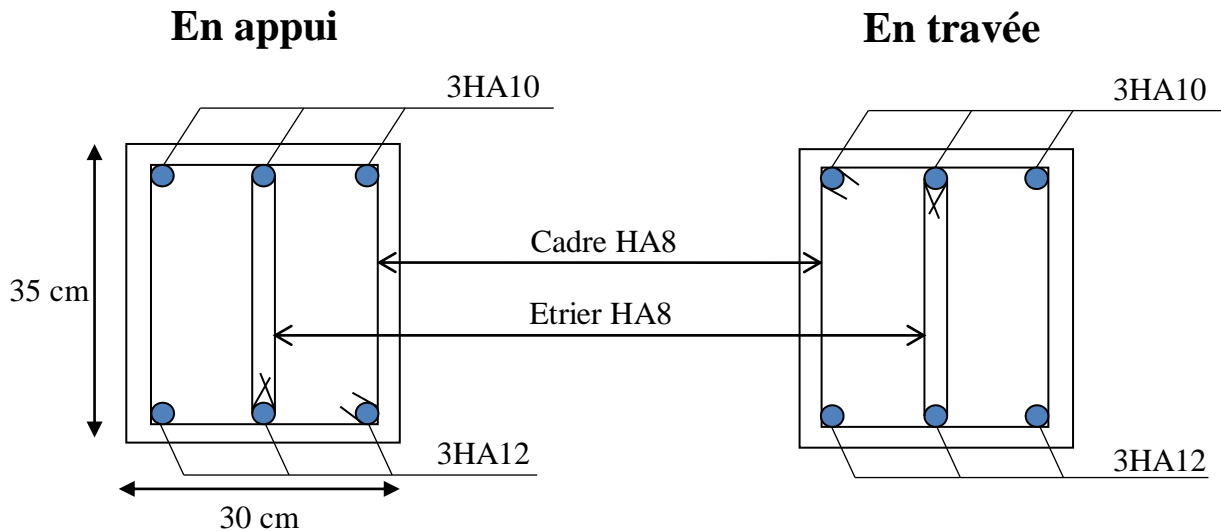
Schéma de ferrailage de la poutre de chaînage
